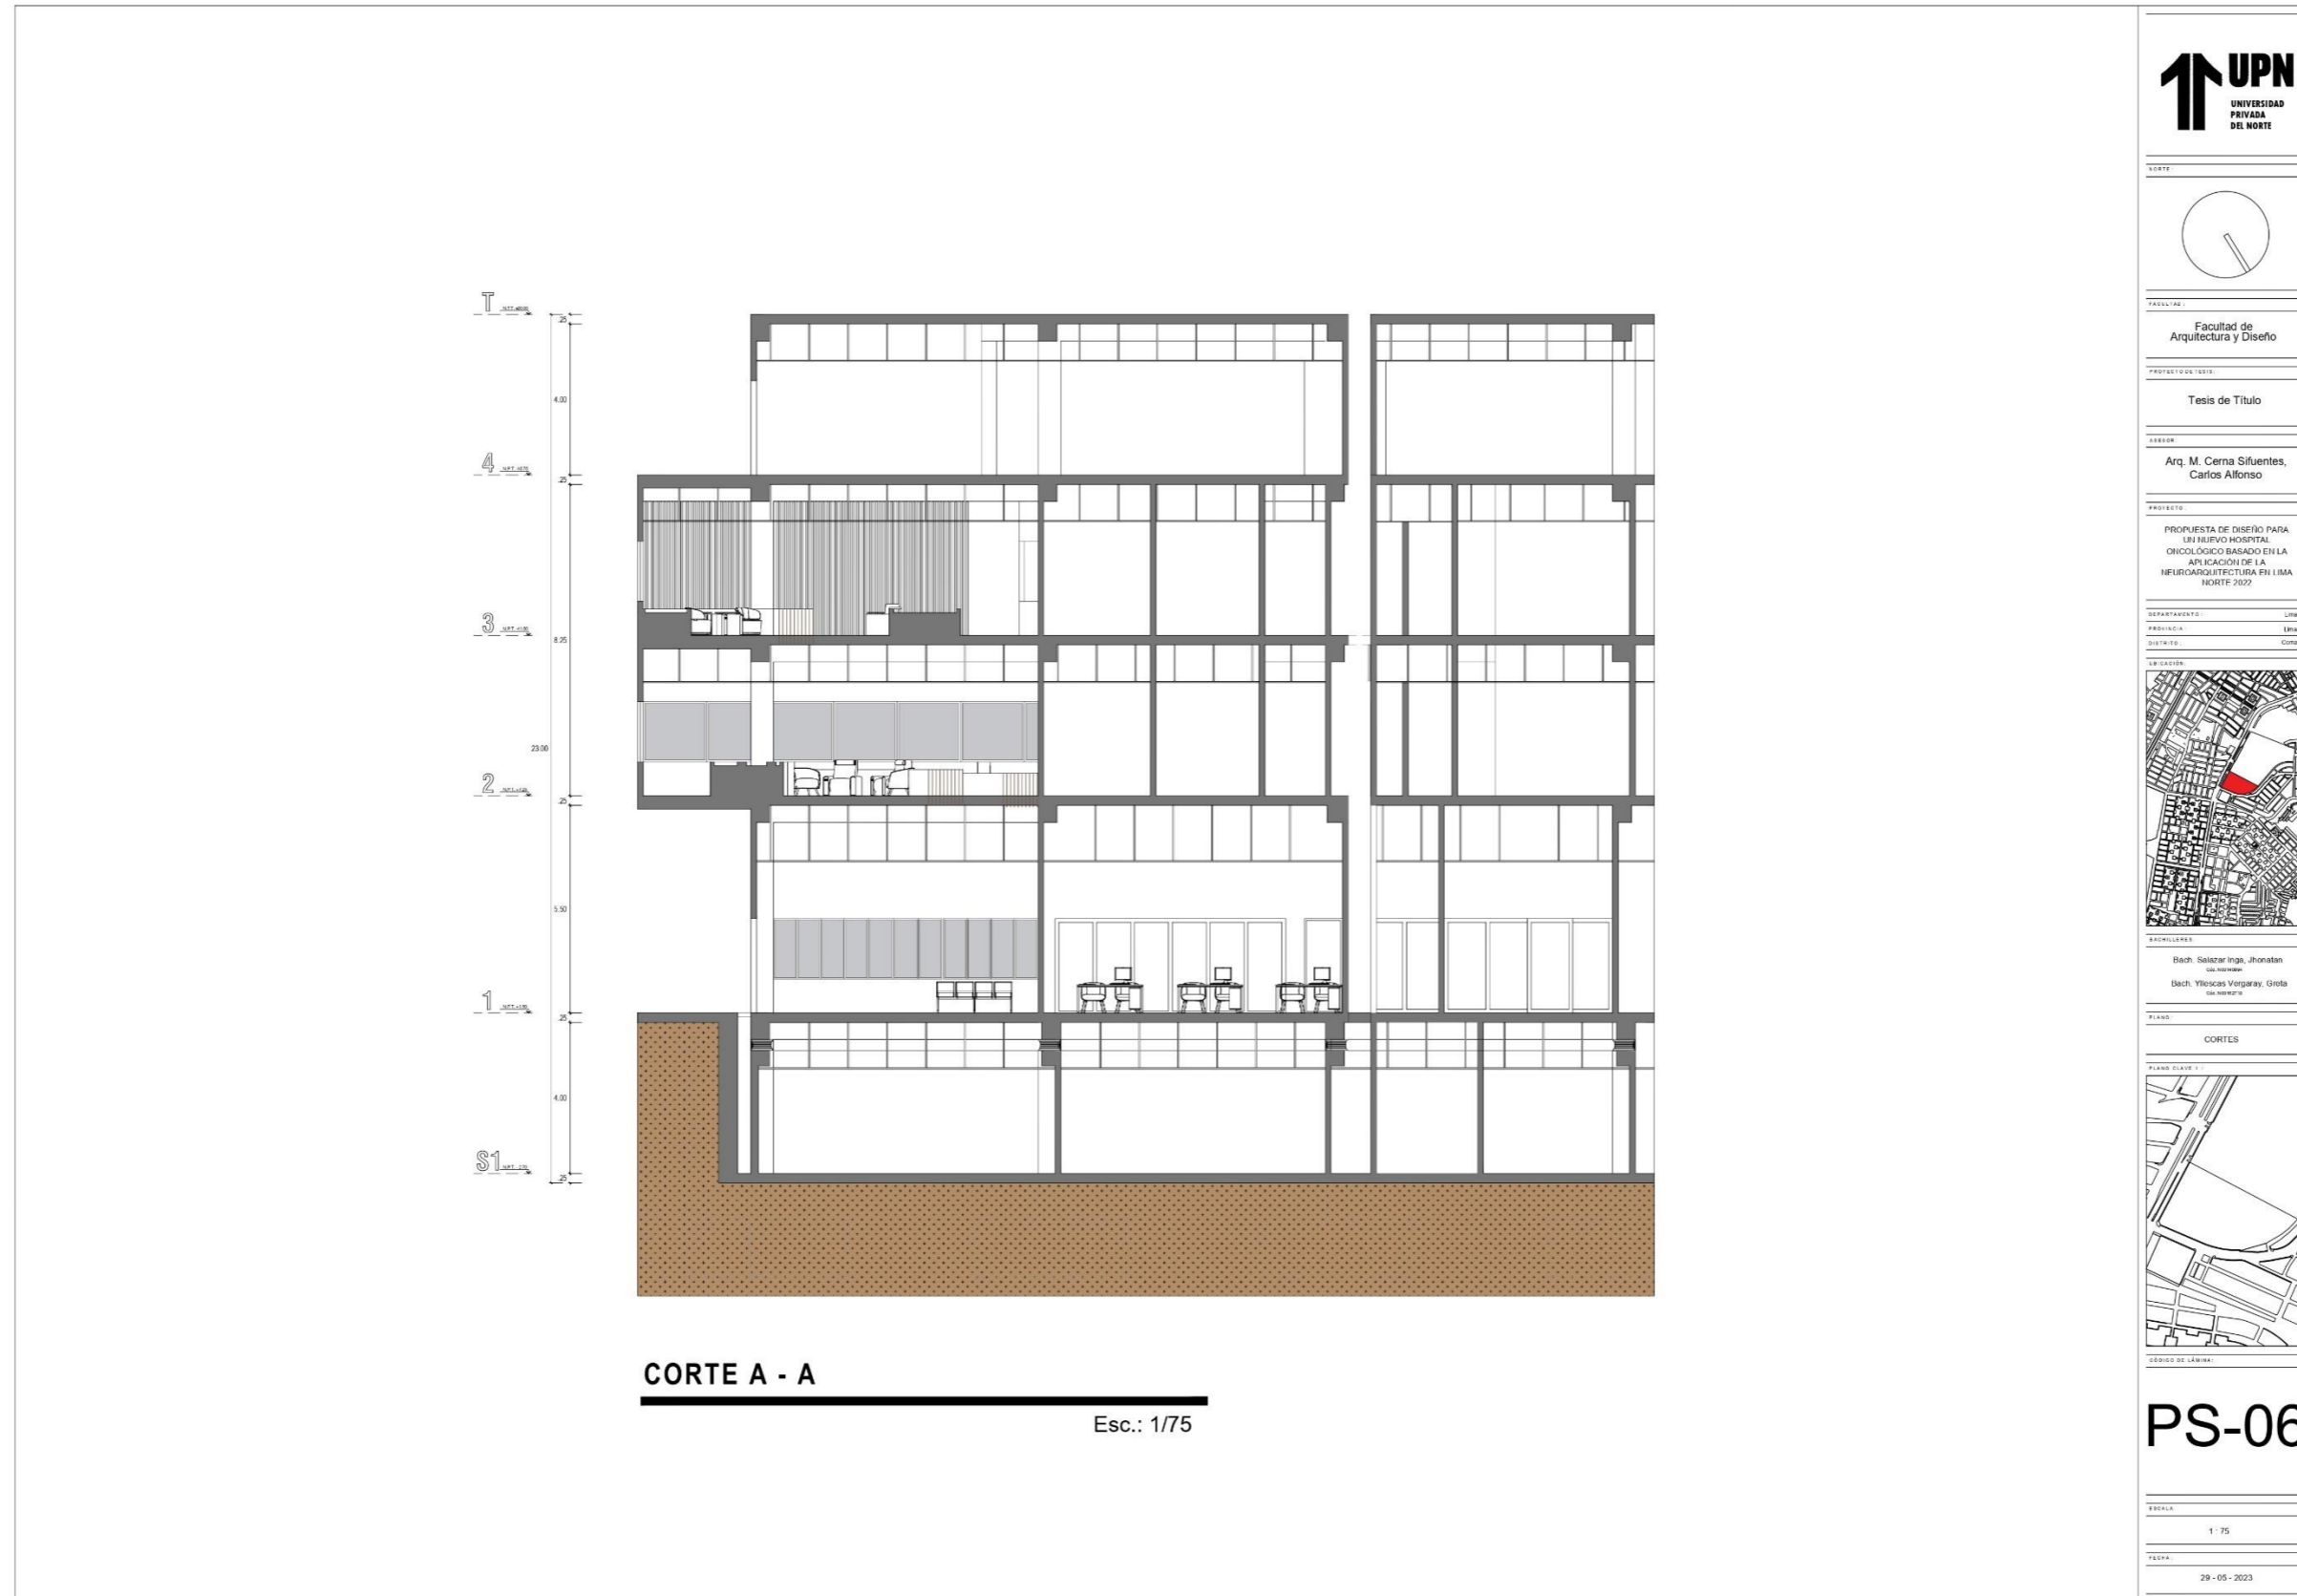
Arquitectura – Cortes N°1 del sector cuadrante Esc: 1/75 (Fuente: Elaboración propia de los coautores)
